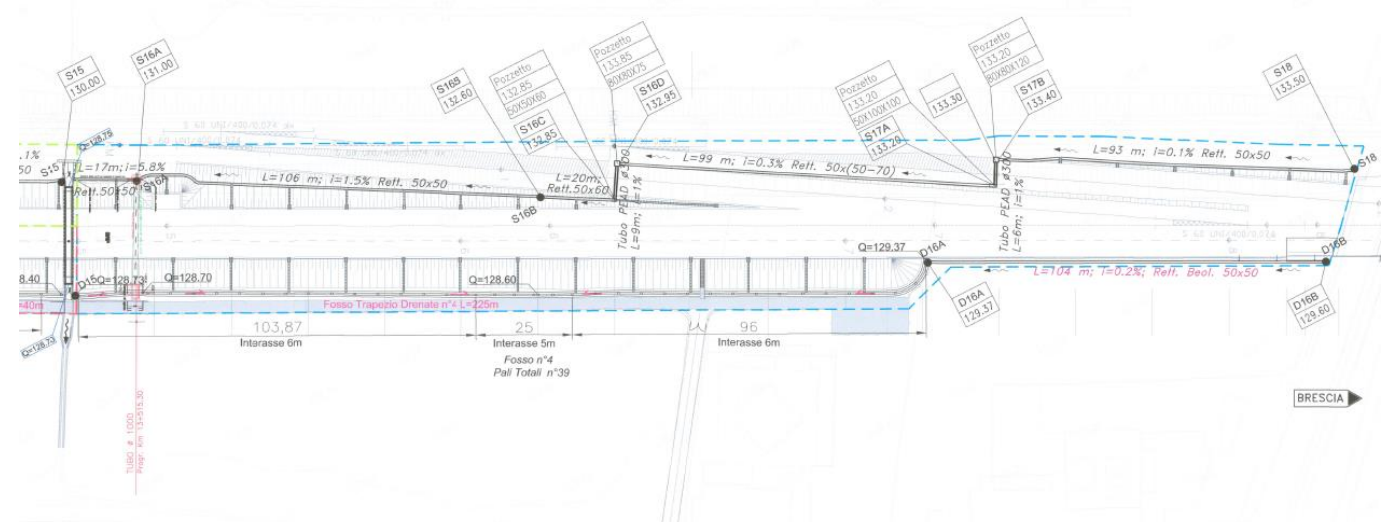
Stralcio sistema di drenaggio attuale – Fonte: Planimetria idraulica IN0101VZZP8RI3503001D
